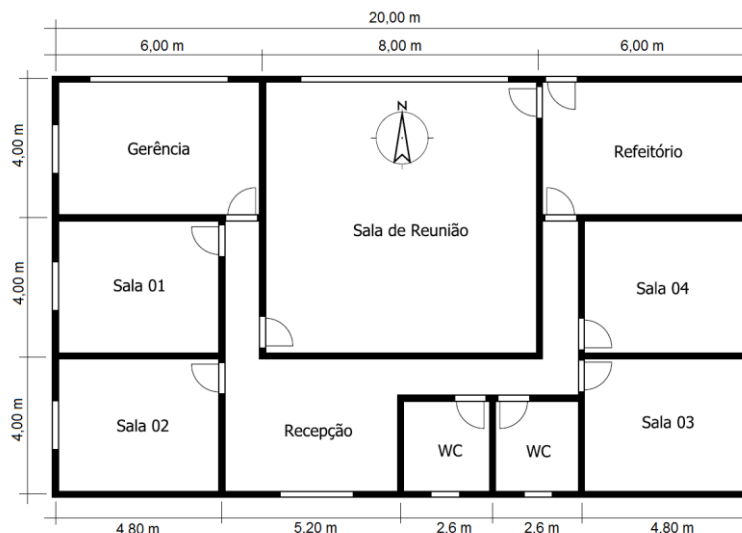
Planta baixa com orientação cardeal e dimensões.
